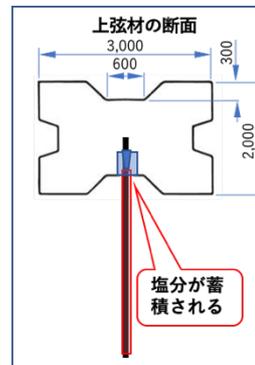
定着部の構造 写真-3 斜材定着点⁴⁾
